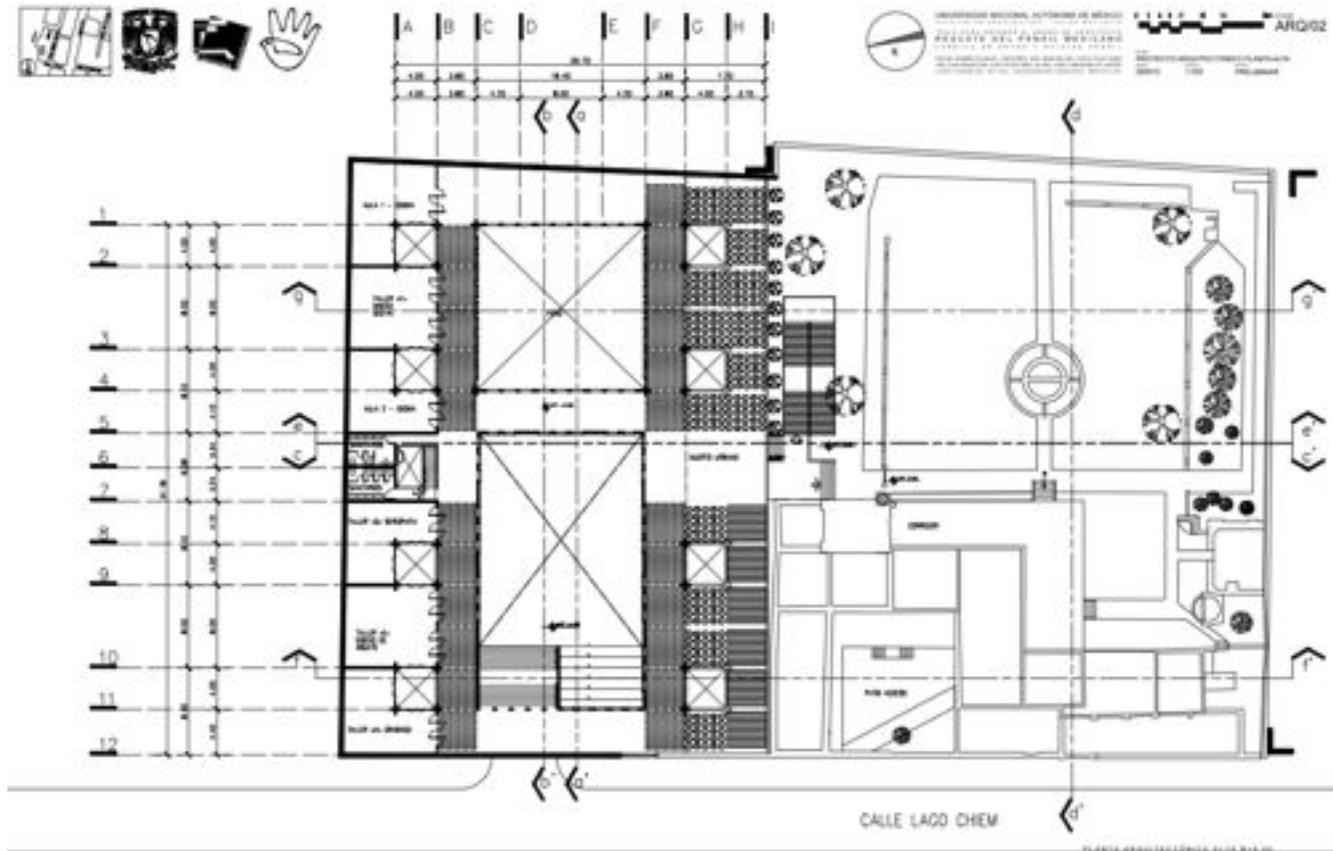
Planta arquitectónica alta. Sobre el acceso existe una pasarela que comunica las alas norte y sur del conjunto. Ésta circulación se repite hacia la mitad del edificio como división entre el foro y la plaza principal, así como al extremo oriente del mismo. El ala sur del edificio cuenta con un solo nivel, como una manera de guardar proporción y respetar a jerarquía del edificio histórico; se propone que la cubierta de este nivel sea usada como huerto urbano y disminuir en esa forma el impacto visual del mismo. El ala norte sí está edificada en dos niveles que repiten el esquema de la planta baja, con un corredor similar al estudio anterior. El foro presenta una doble altura, que es ad hoc con la escala que presenta. La contención espacial es llevada suavemente por la continua aparición de espacios a cielo abierto.
